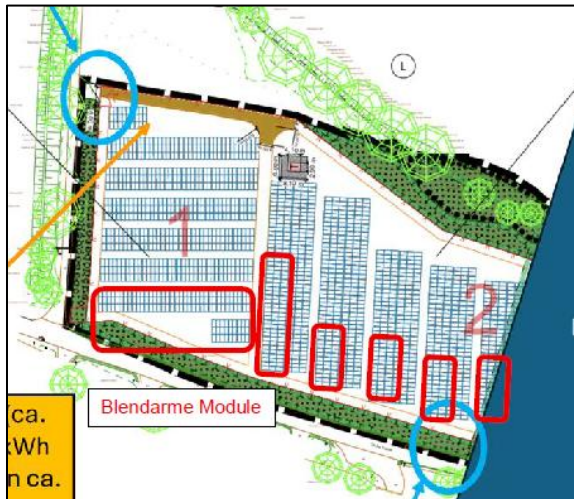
Position der blendarmen Module gem. dem vorläufigen Layout, Quelle: Blendgutachten S. 29.
